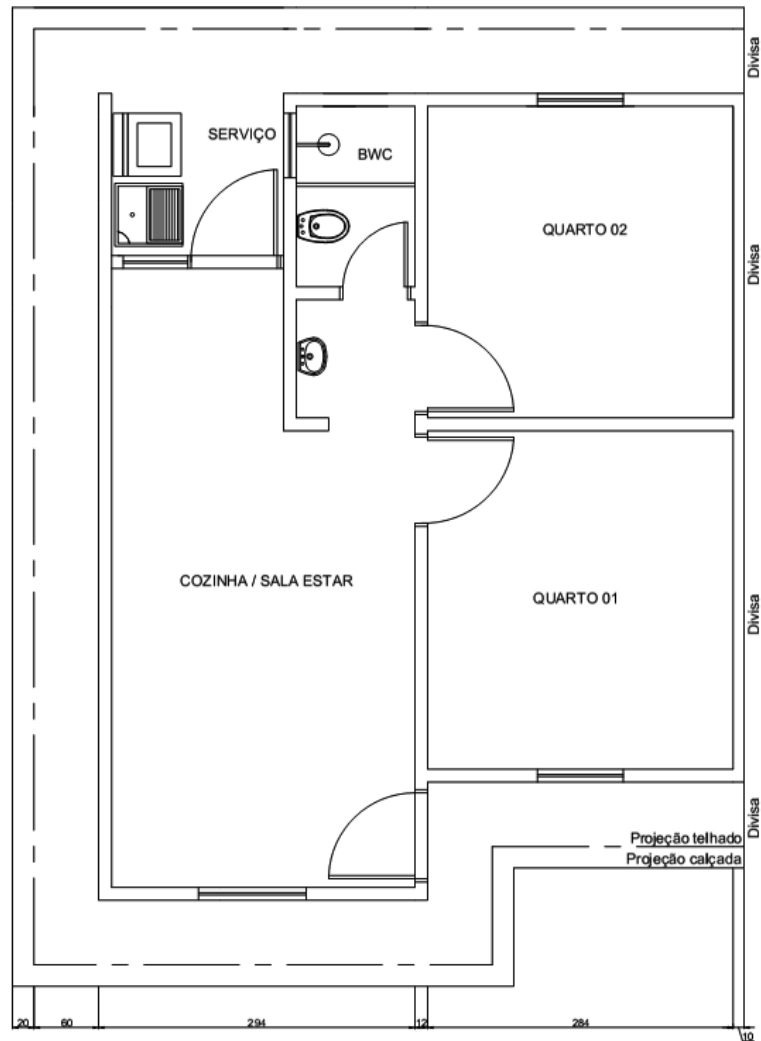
Projeto da planta baixa do Residencial Jardim das Orquídeas
